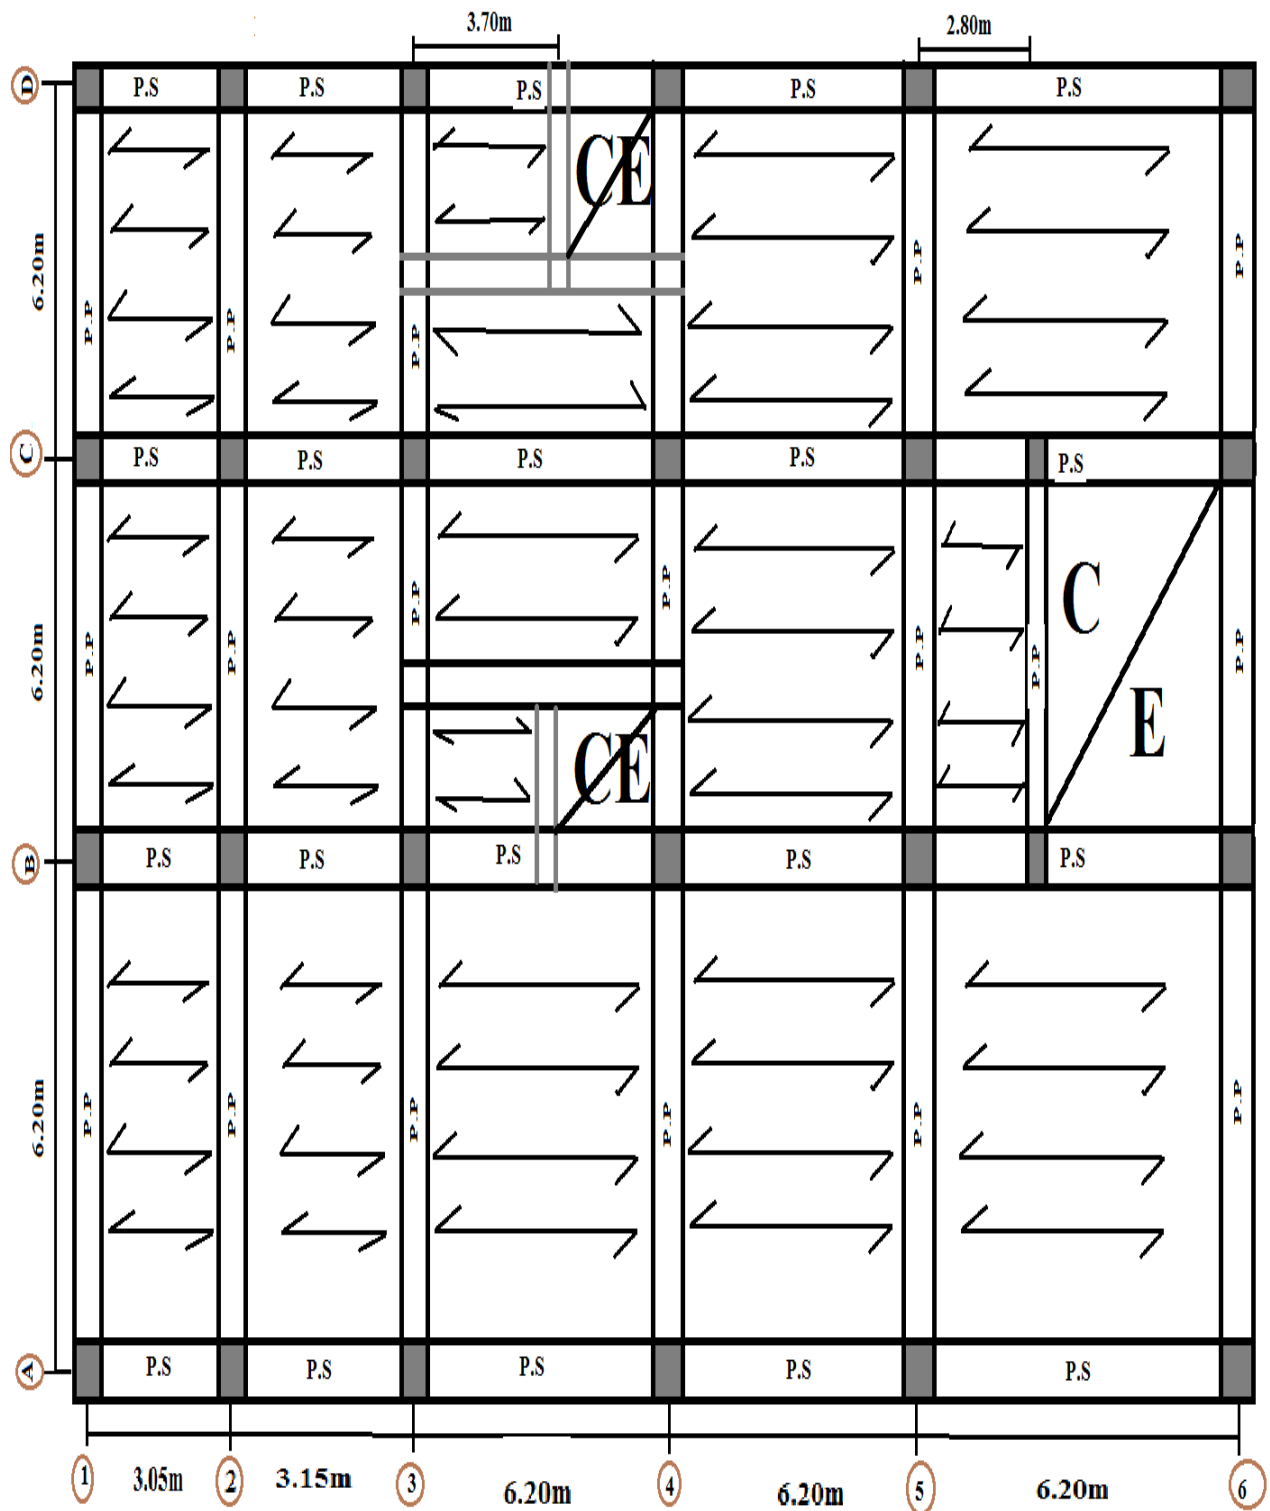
a Disposition des poutrelles du RDC Et Sous-sol
